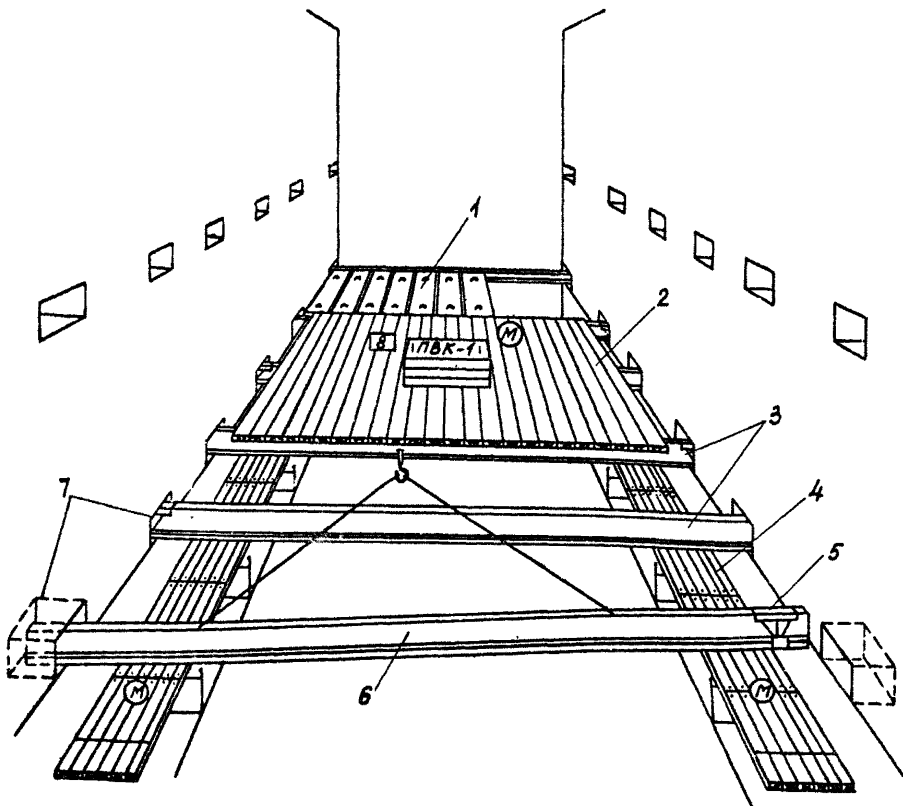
Схема организации работ по монтажу участка перекрытия из железобетонных балок ОБТ с протезами ПР-1 и межбалочным заполнением из плит ПКВ-1;
